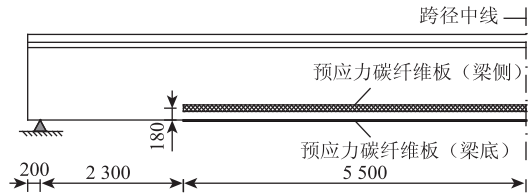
预应力碳纤维板纵向布置图 (单位: mm)
